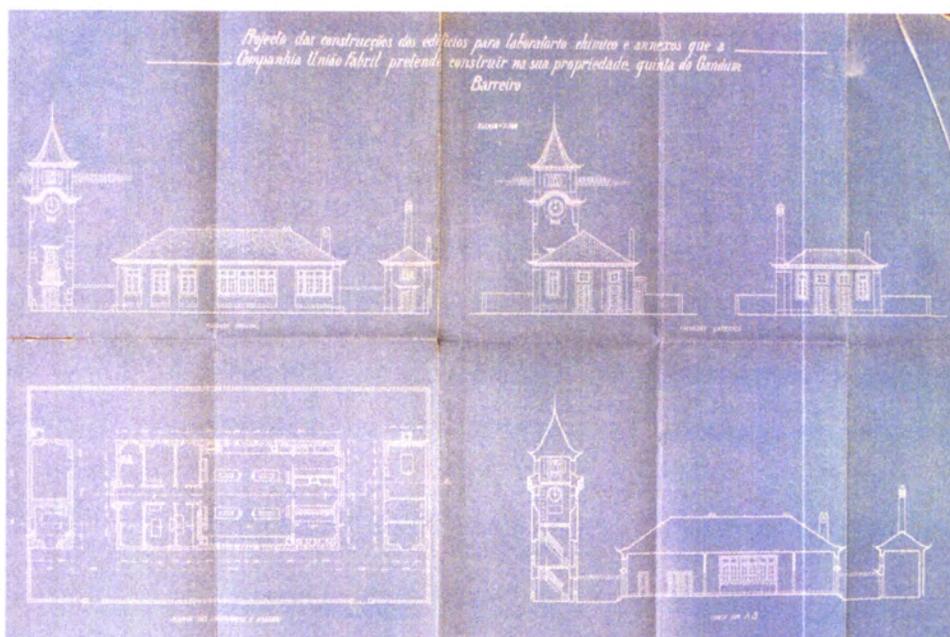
Planta do Bairro Operário. Edifício do Laboratório e anexos.
